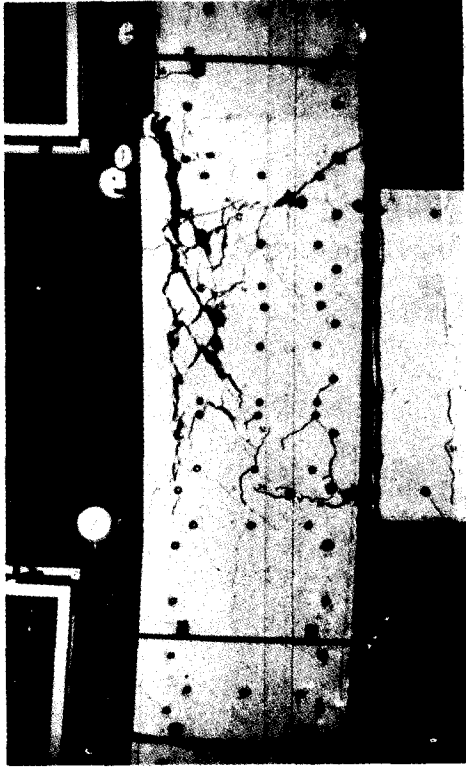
Unión viga-columna exterior de concreto reforzado mostrando grietas longitudinales a lo largo de las varillas exteriores de la columna
